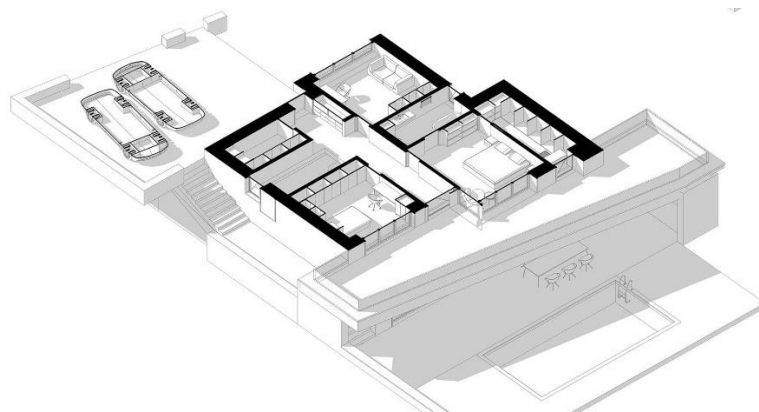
Переріз на рівні першого поверху будинку WHITEWOOD MD HOUSE, Харків [38]
